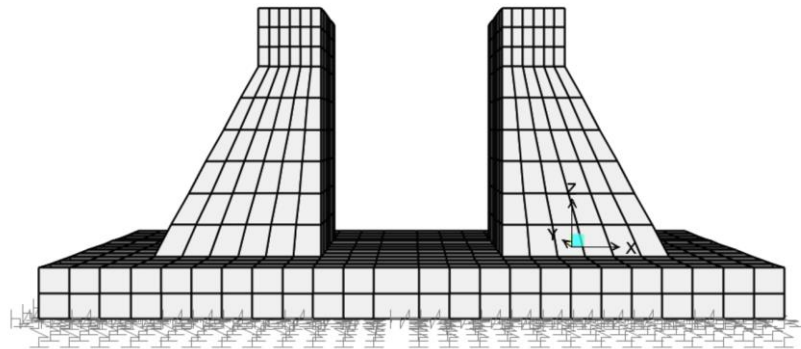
Sistema sin aisladores - Vista: Elevación.
